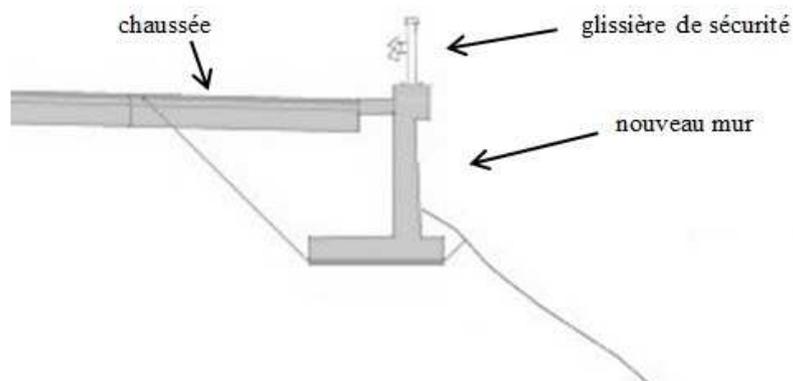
Mur à semelle arrière, longueurs 22 m et 16 m de part et d'autre du mur poids central
